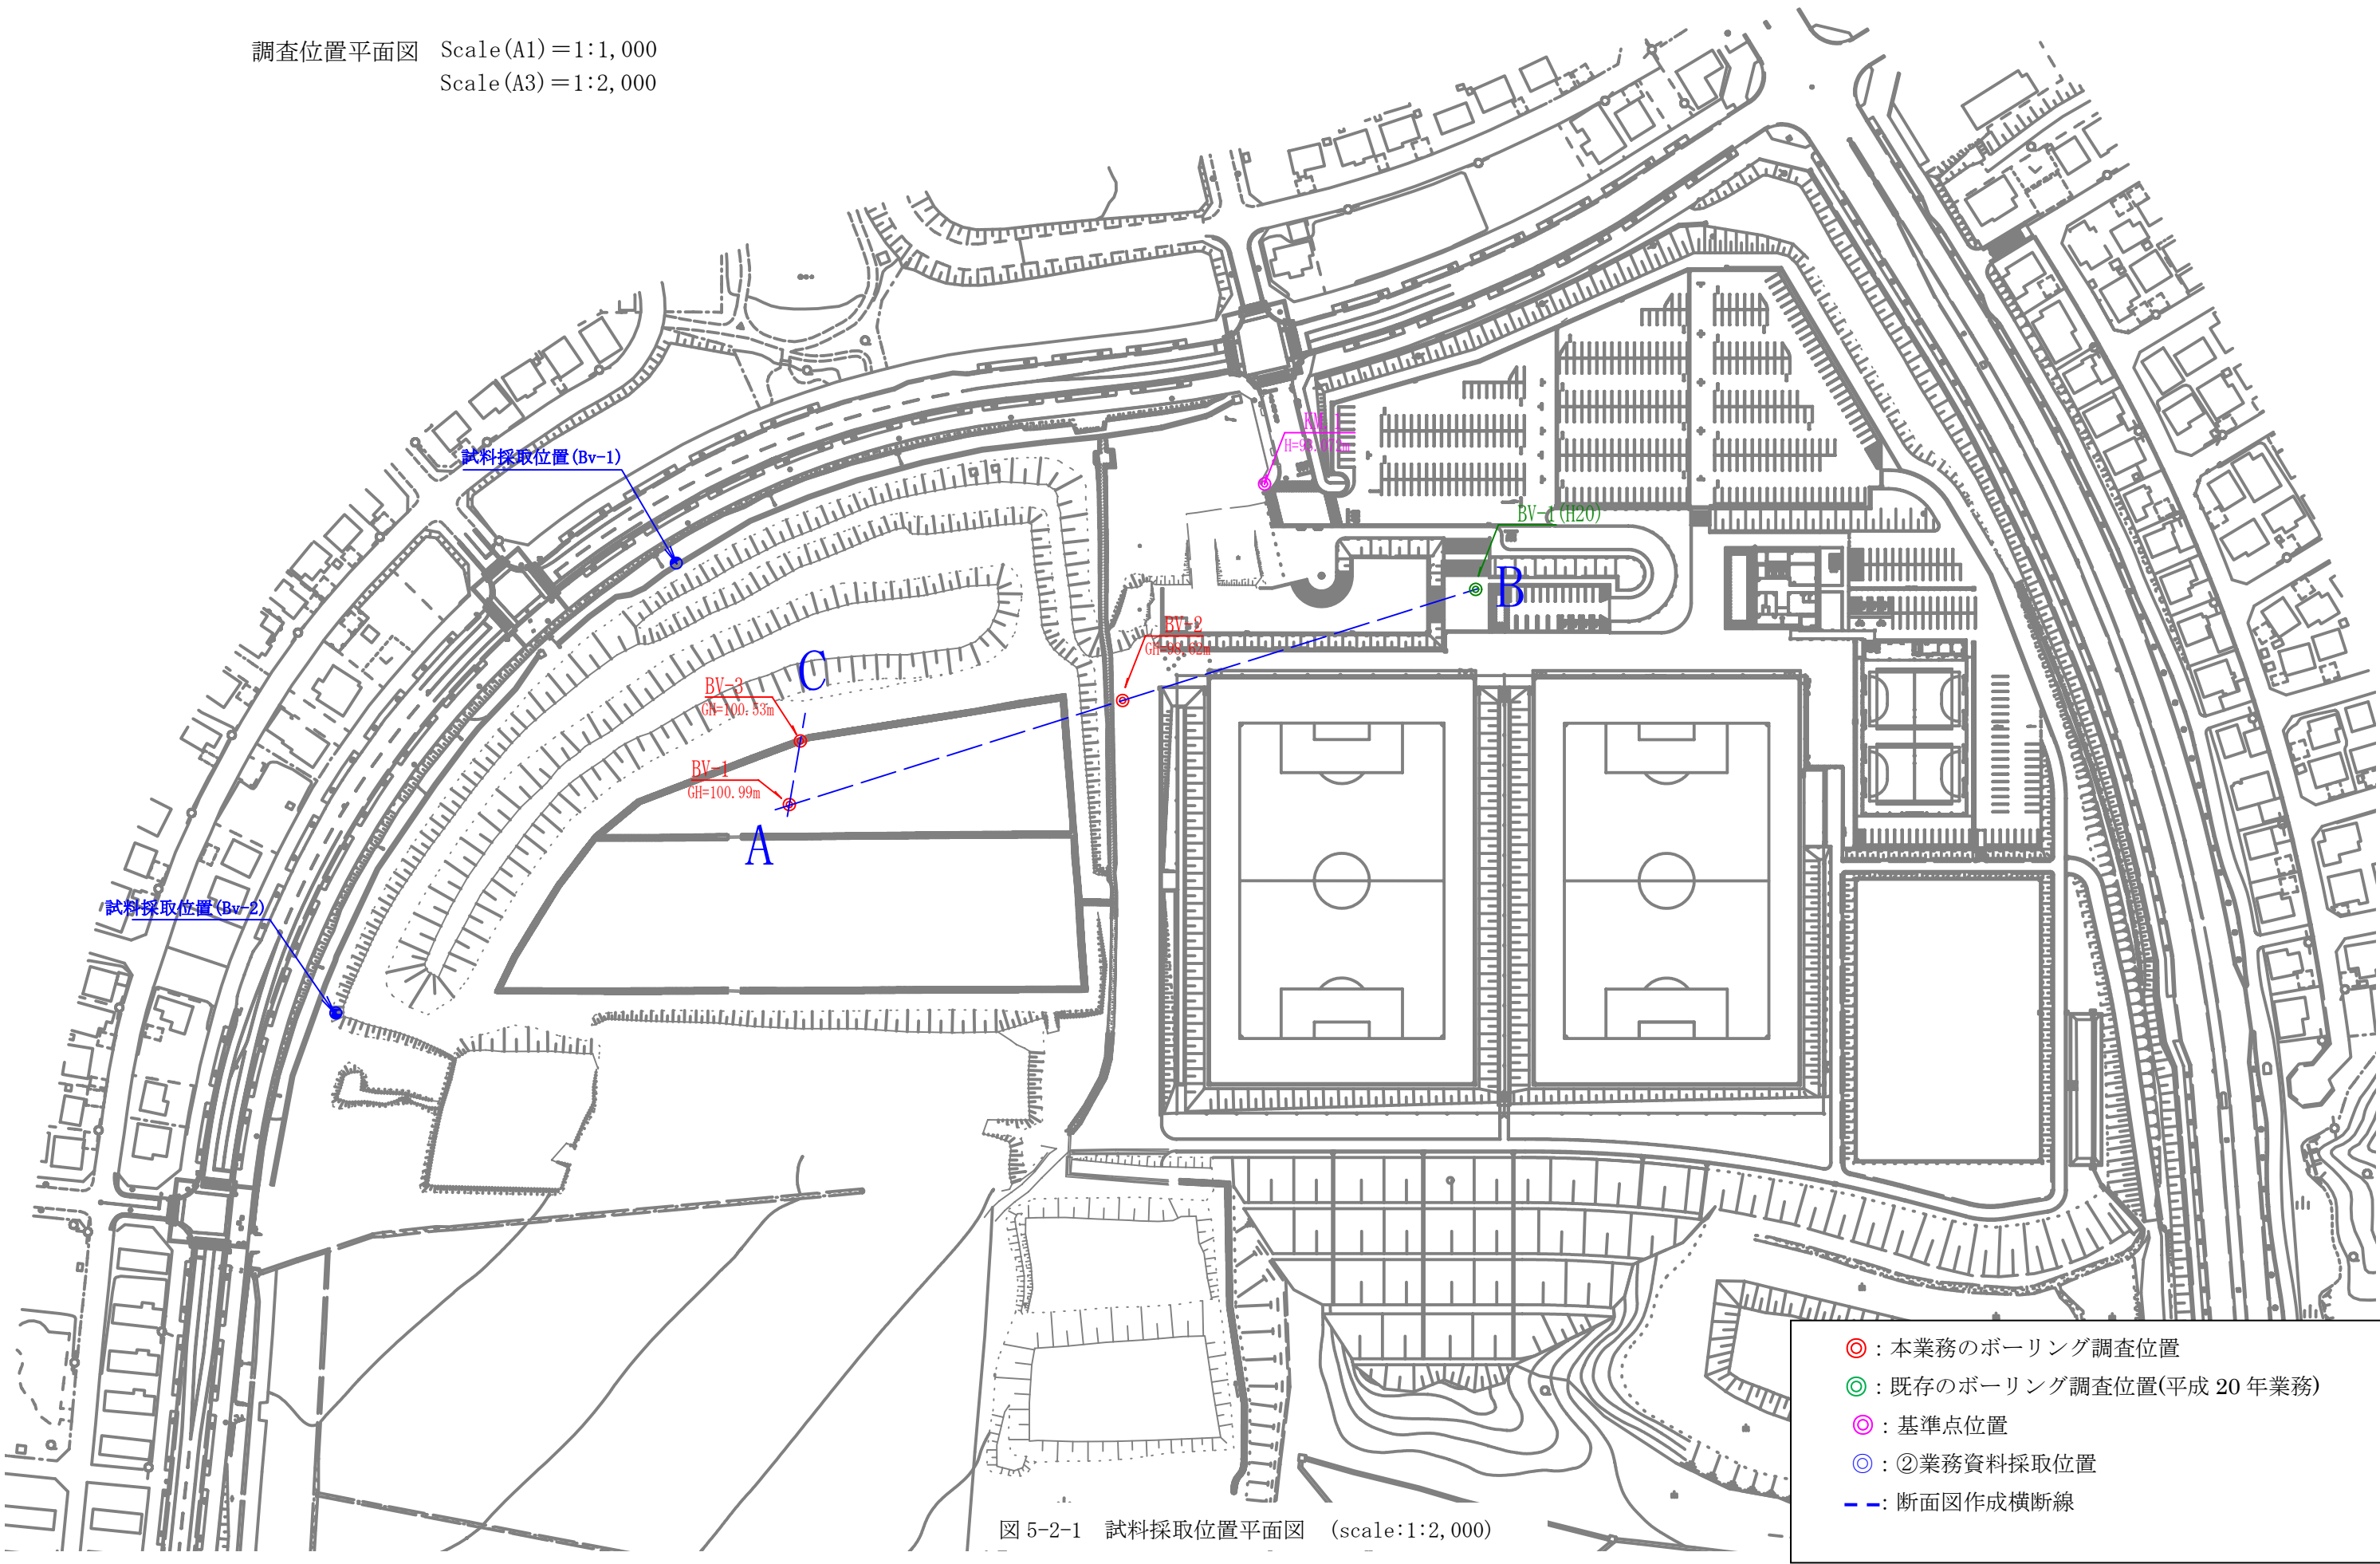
試料採取位置平面図 (scale:1:2,000)
